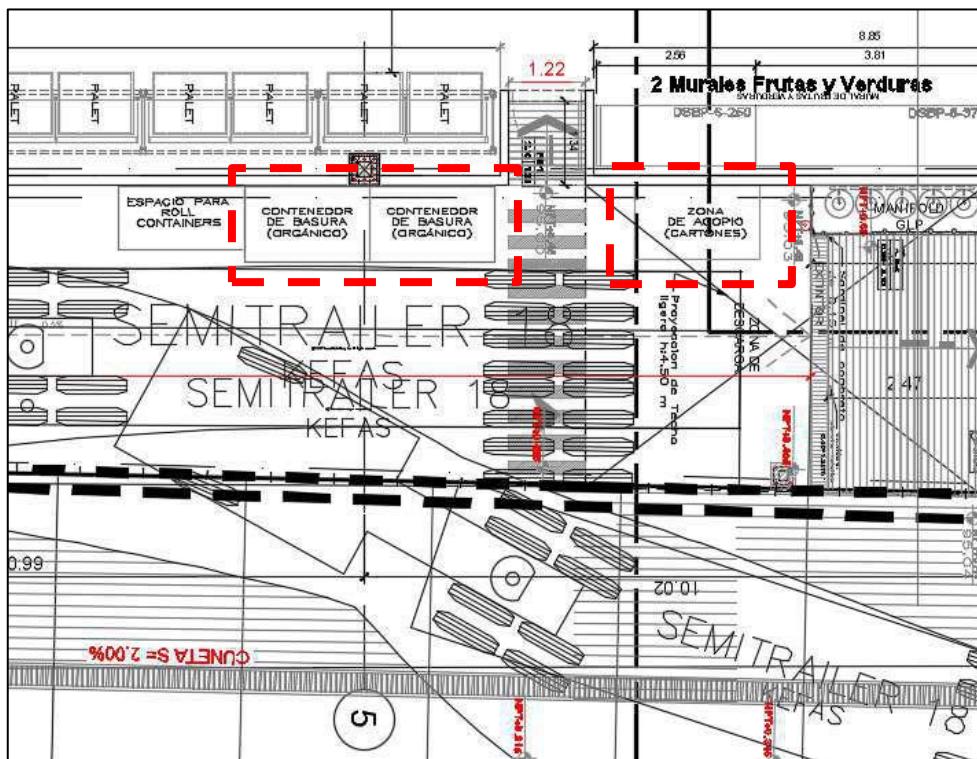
Plano Arquitectura- zona de contenedores de basura.
